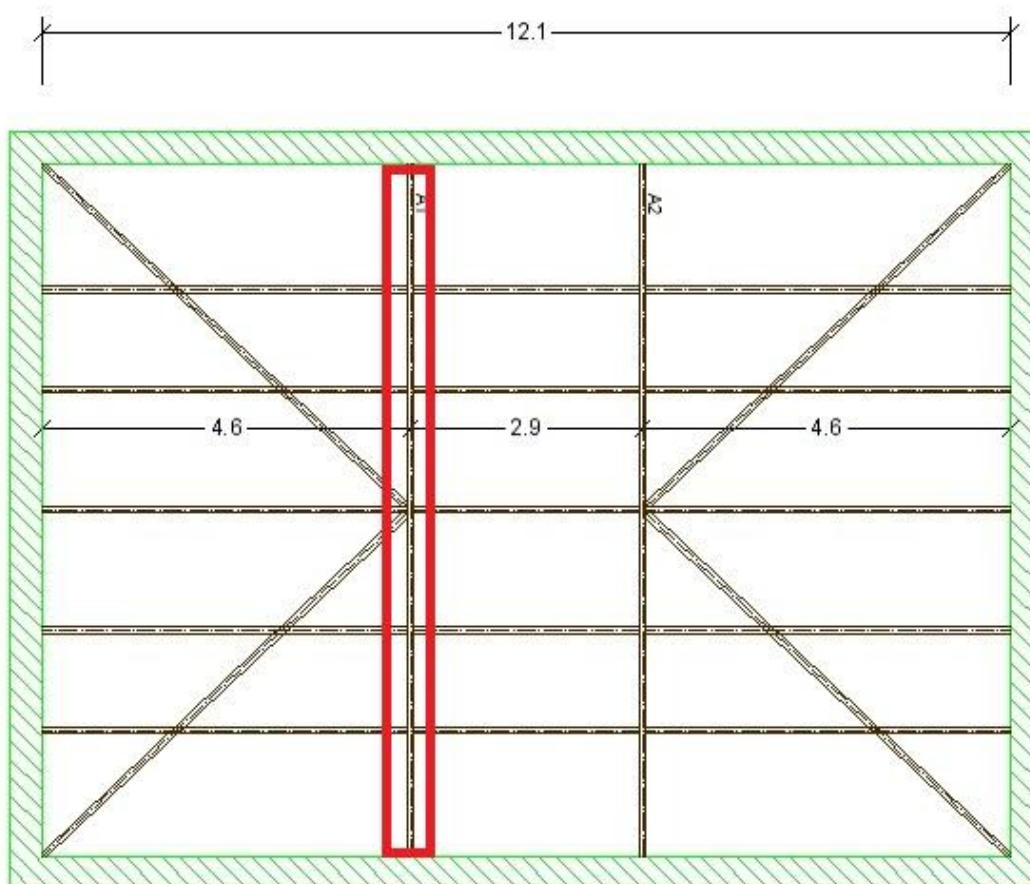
Localização em planta dos ensaios na cobertura, A1
